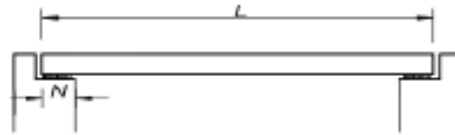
Longitud mínima de apoyo, en Puente Simplemente Apoyado.
